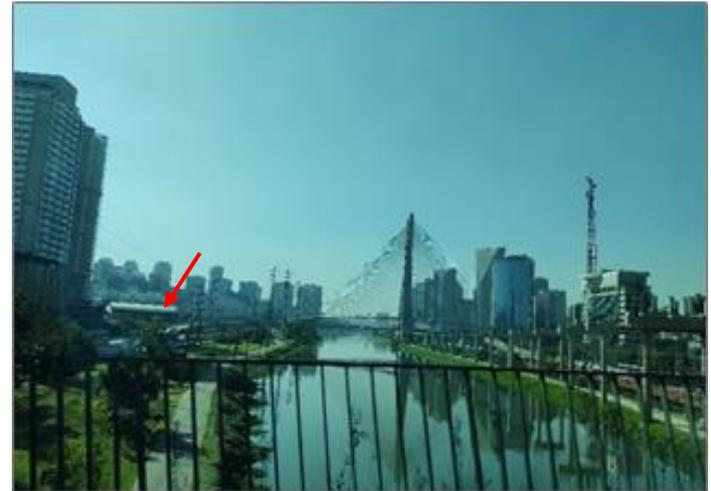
Vista geral do rio Pinheiros em relação ao empreendimento.
